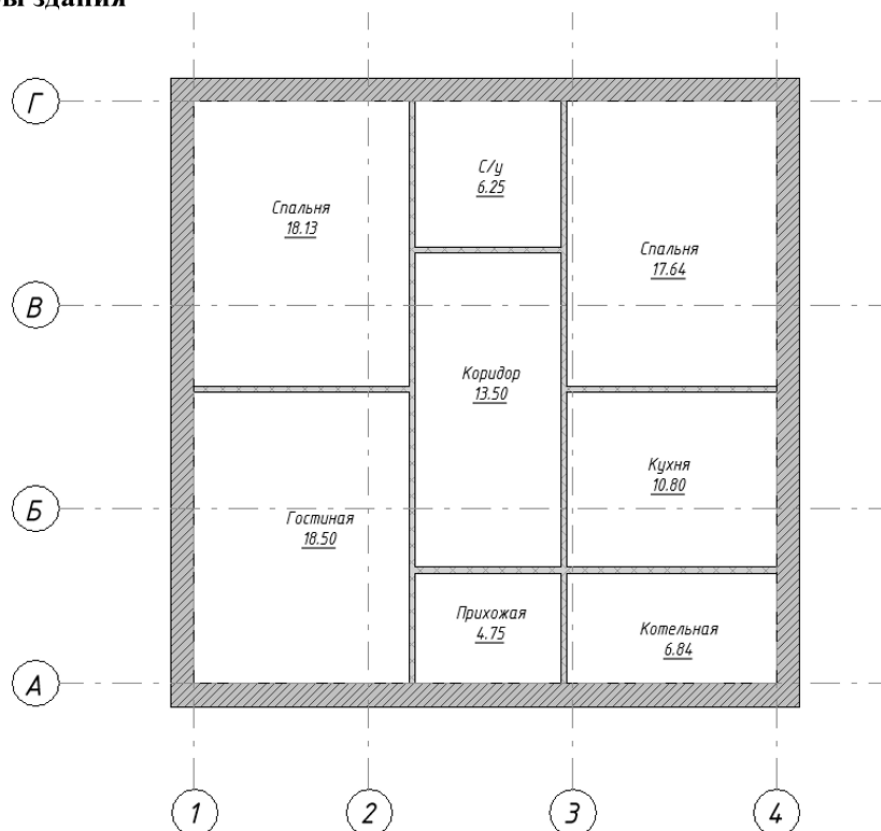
План 1-го этажа малоэтажного жилого здания
